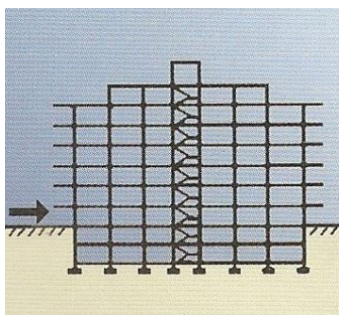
Ilustração do tipo de estrutura dos primeiros edifícios de betão armado
